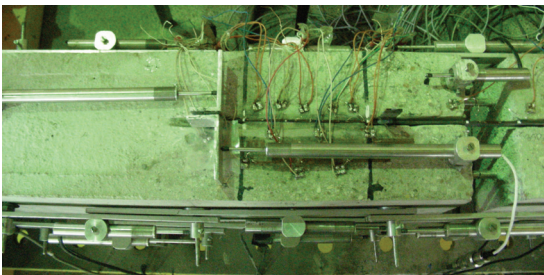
Położenie tensometrów elektrooporowych na powierzchni betonu
